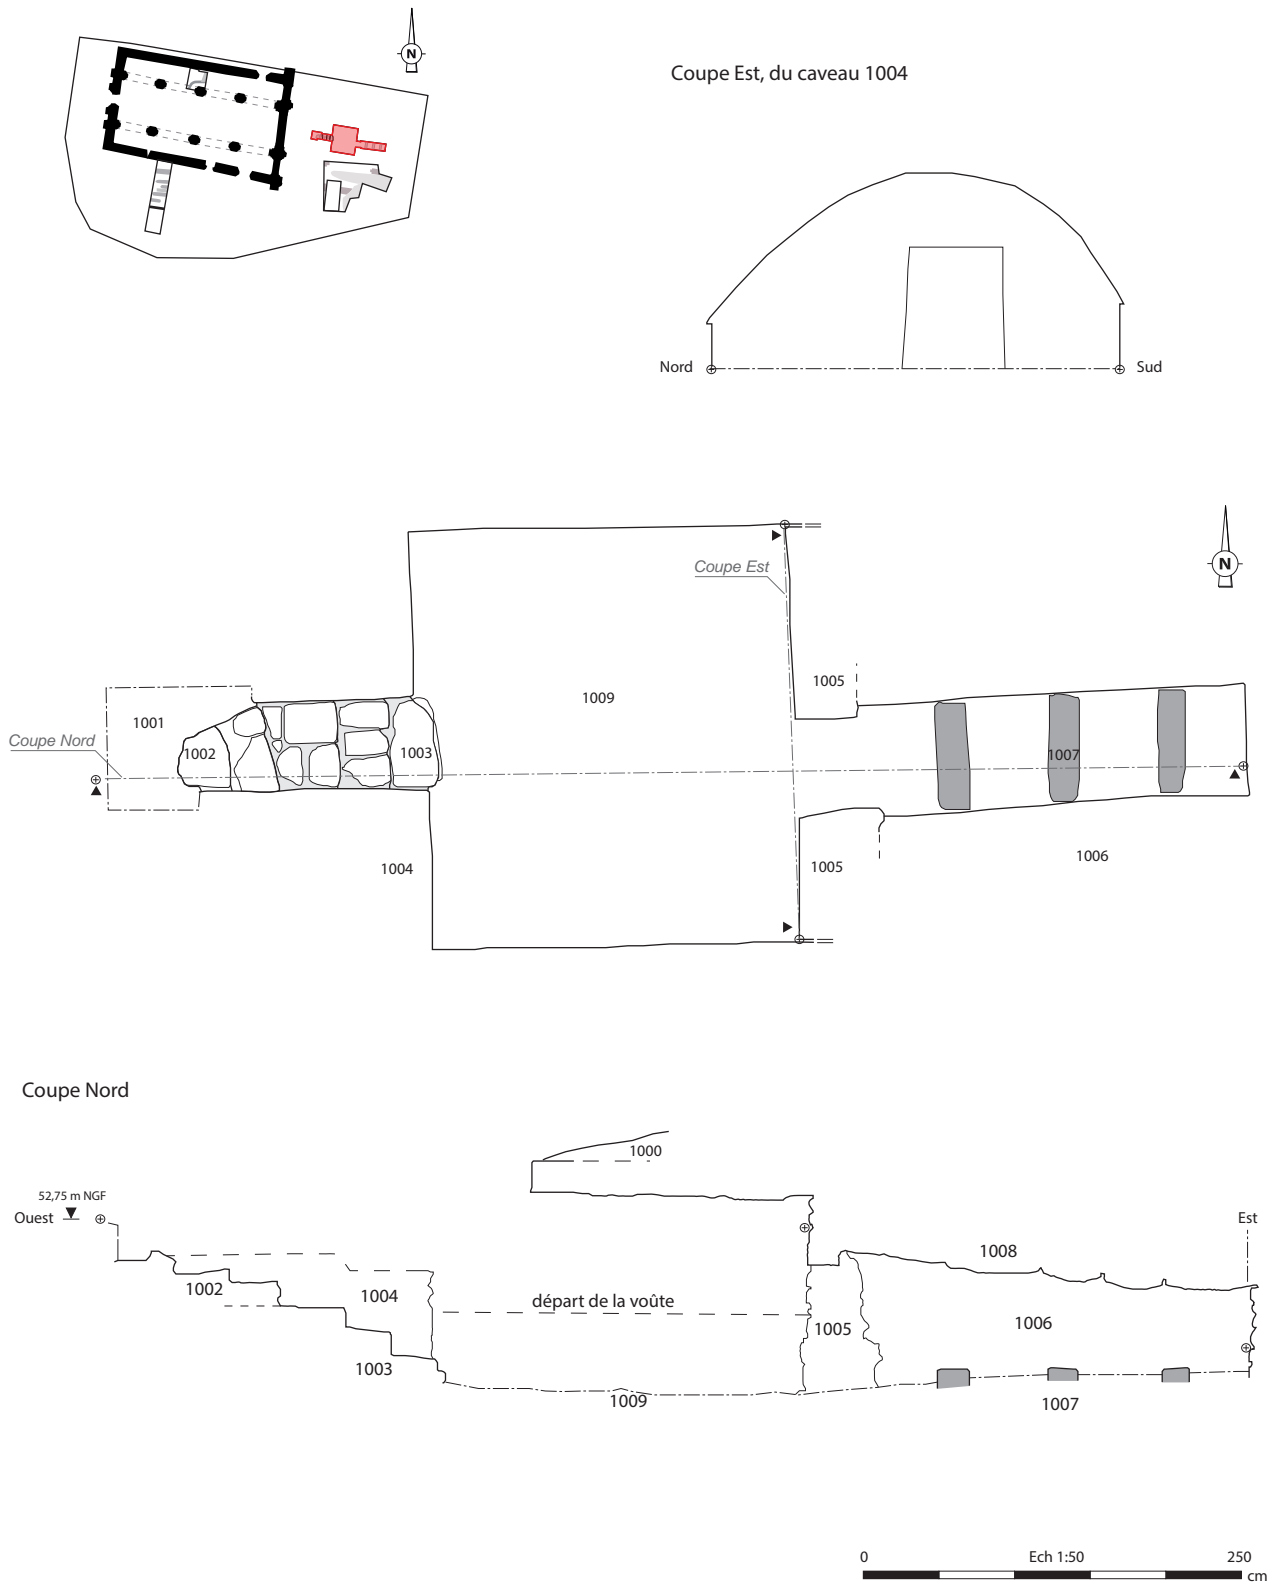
Plan et coupes longitudinale et transversale des caveaux © M. Millet, Inrap
